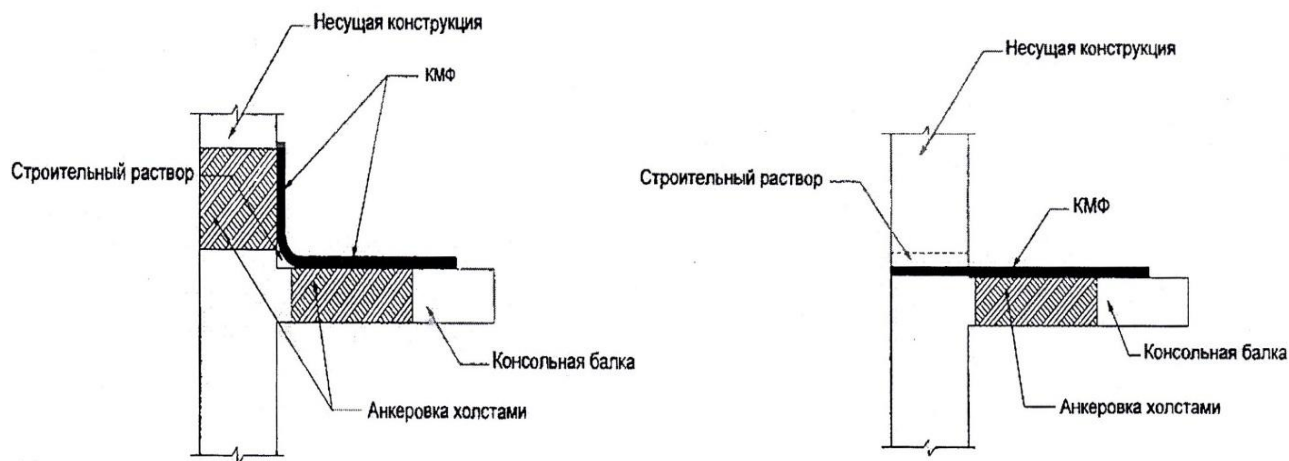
Анкеровка композитных материалов для консольных конструкций
